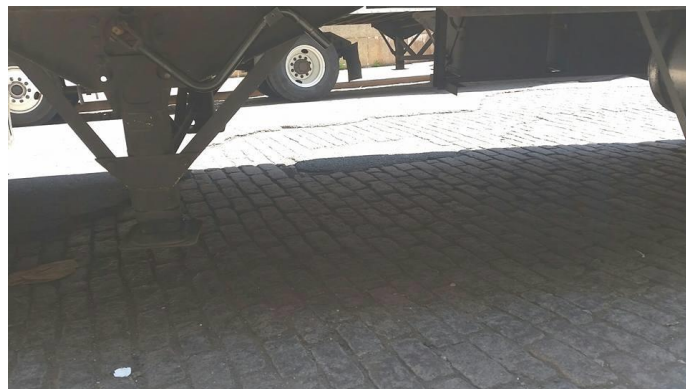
Estructura de pavimento articulado (adoquinado) sometido a cargas en la ciudad de Nueva York (Fuente propia)
